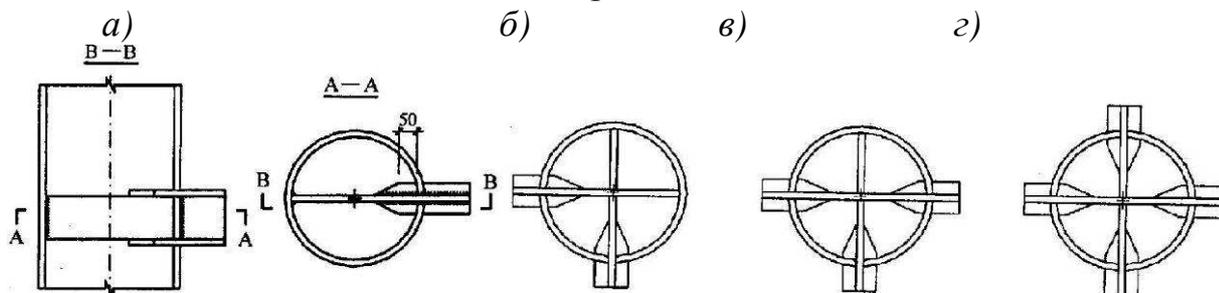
Узлы соединения между сталежелезобетонными колоннами и железобетонными балками: а – узел крепления несущего кольцевого ребра; б, в, г – возможные варианты расположения несущего кольцевого ребра: б – угловая колонна; в – крайняя колонна; г – средняя колонна
